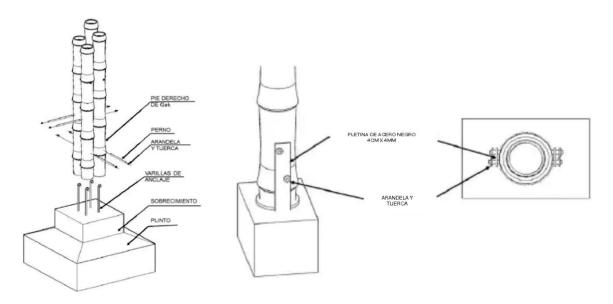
Cimientos con el uso de zapatas para elevar el bambú
